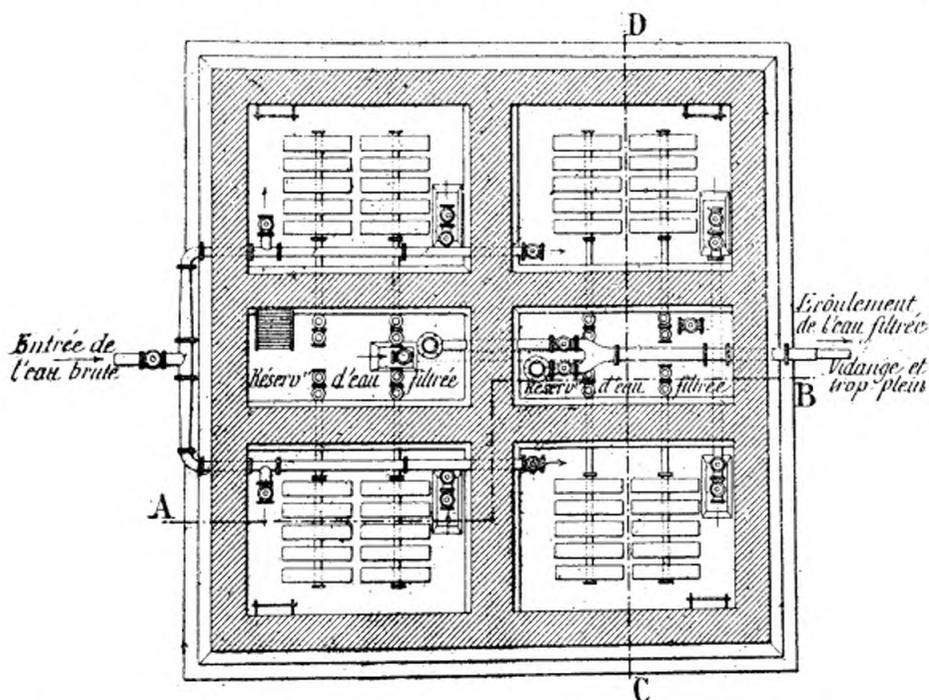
a. — Plan du système Fischer (plaques filtrantes). — Installation de Worms
